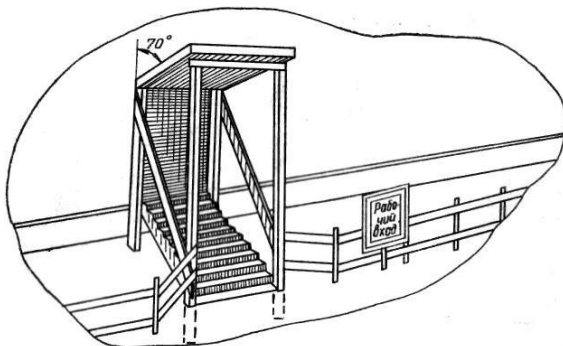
Улаштування захисного козирка над входом будівлі, що будується
